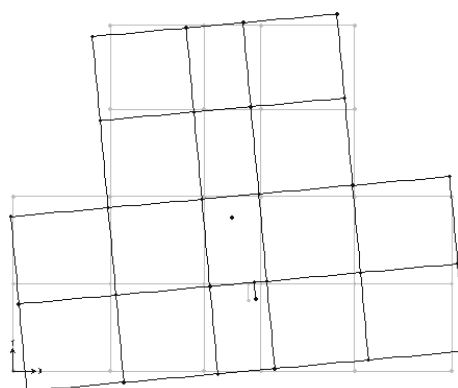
Disposizione in pianta dei dispositivi di isolamento (caso b)
